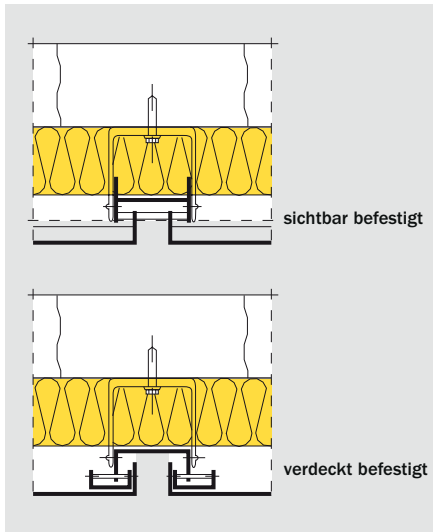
Aluminium-Kassetten mit hängender Befestigung
